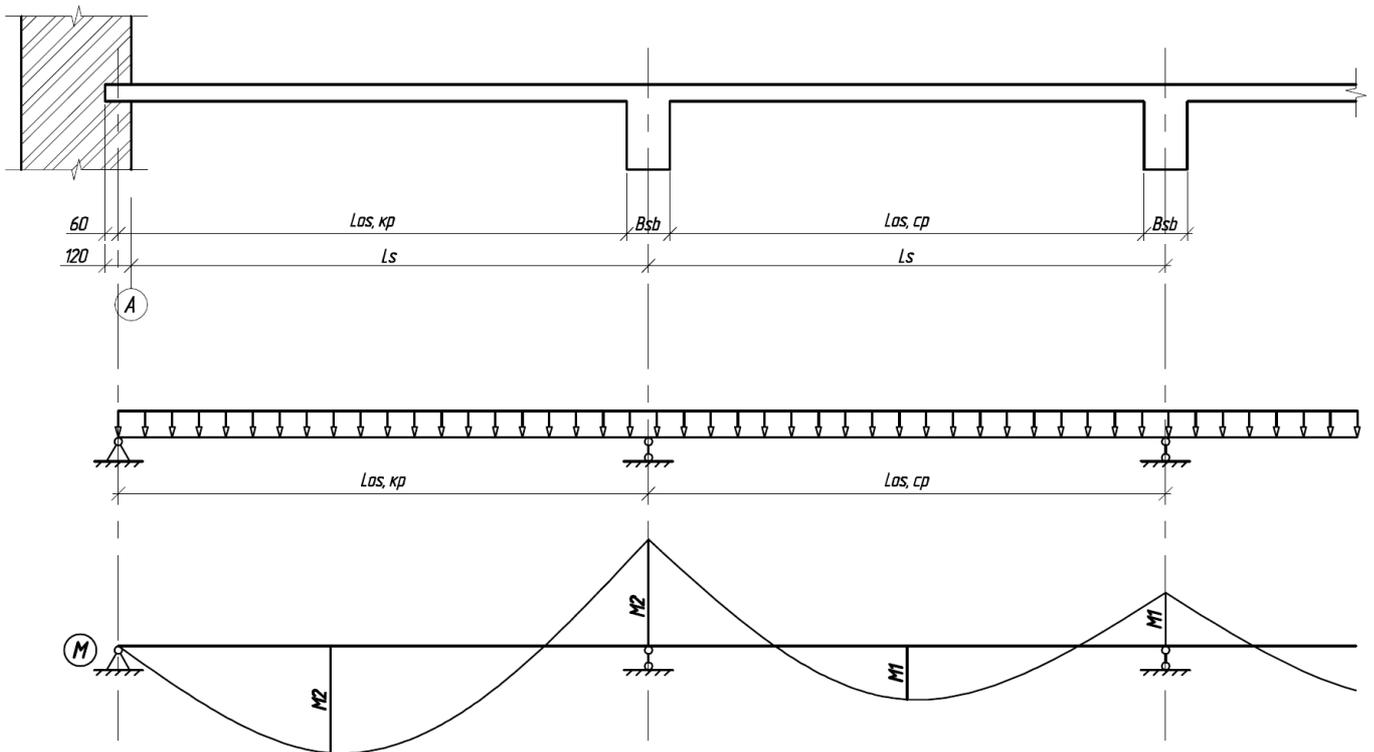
Расчетная схема плиты и эпюра изгибающих моментов
